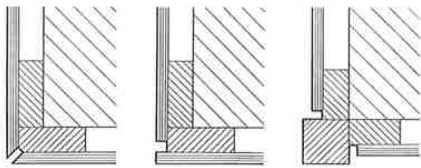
Assemblages d'angle des revêtements horizontaux.
